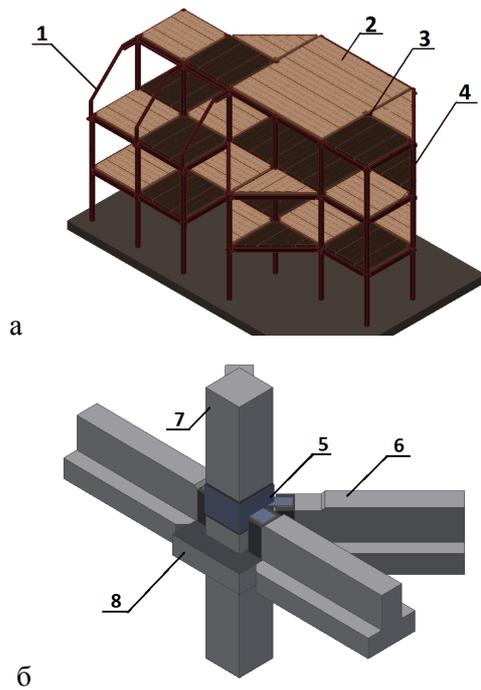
Каркасная система «ИКАР»: а – каркас; б – узел опирания ригелей на колонну: 1 – мансардная рамка; 2 – панель; 3 – узел опирания ригелей; 4 – колонна; 5 – узловой металлический элемент; 6 – ригель; 7 – верхняя колонна; 8 – нижняя колонна
